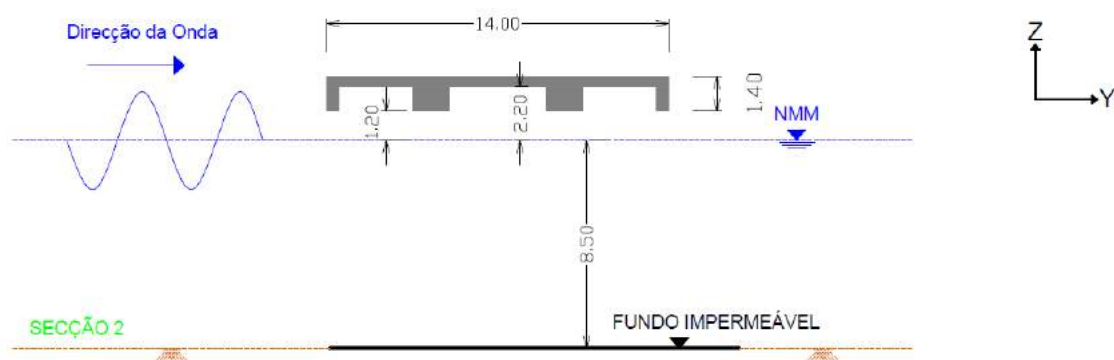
Secção transversal 2 da Ponte-Cais e respetivas dimensões em metros.
